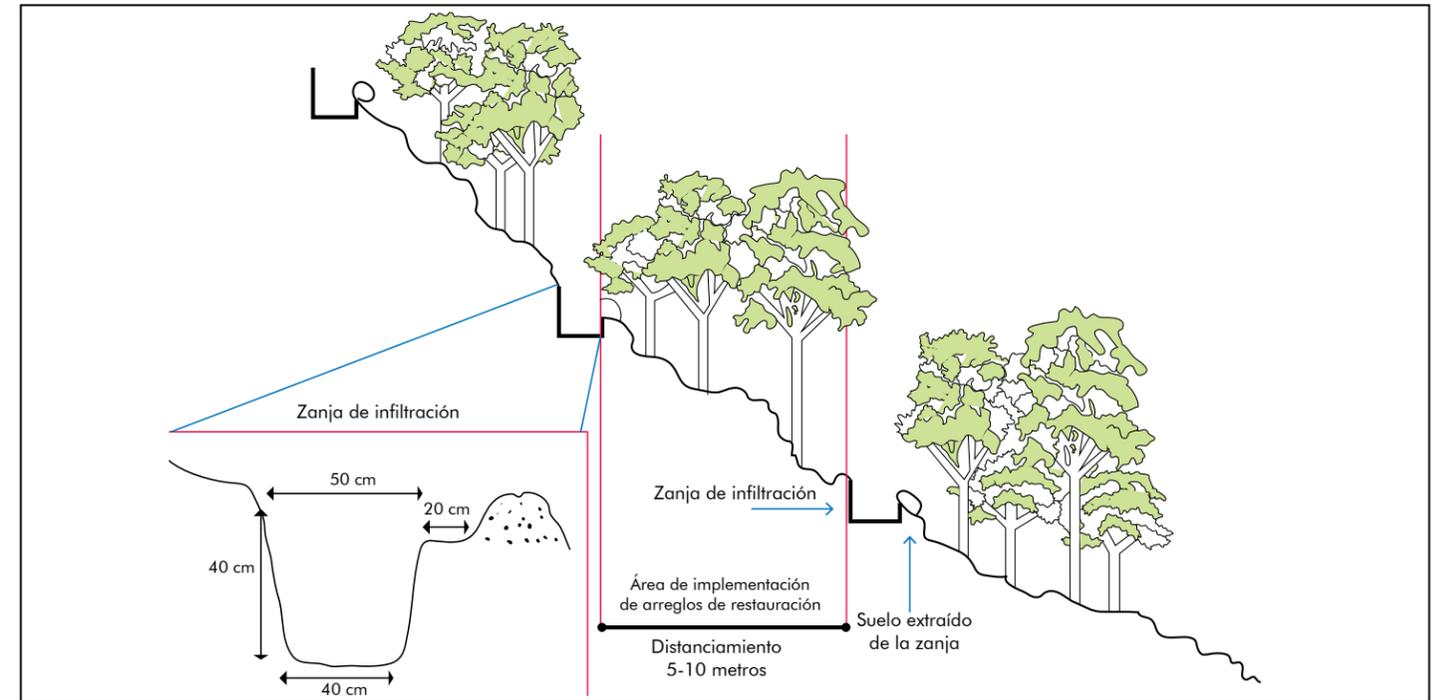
Vista de perfil y dimensiones de las zanjas de infiltración con la implementación de modelos de restauración ecológica
